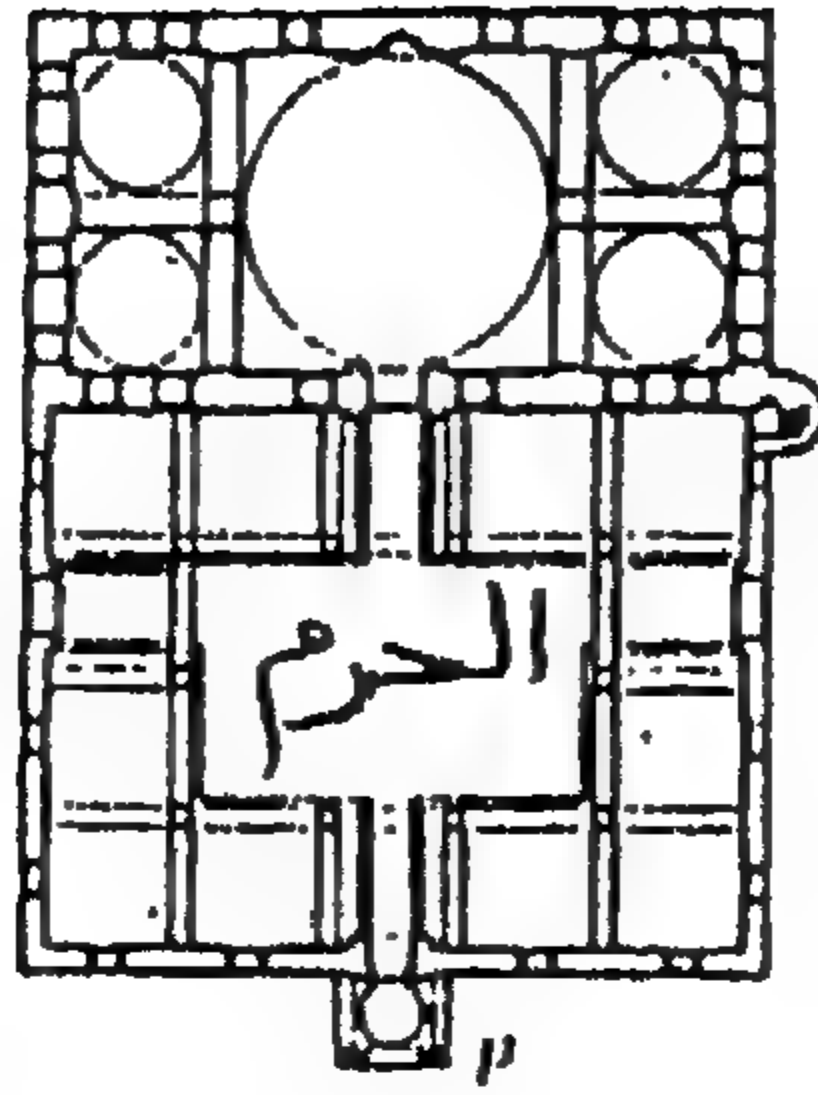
مسقط أفقي لمسجد طلختان بابا قرب مرو . (عن : Kuban) .
